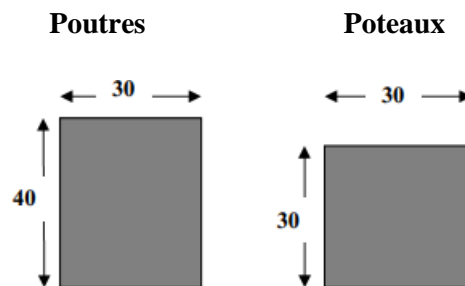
Dimension des sections de béton des poutres et des poteaux de structure.
